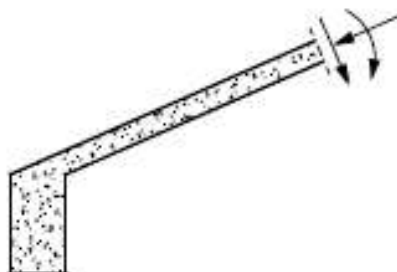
Viga de extremidade onde apoia uma laje inclinada [17]
